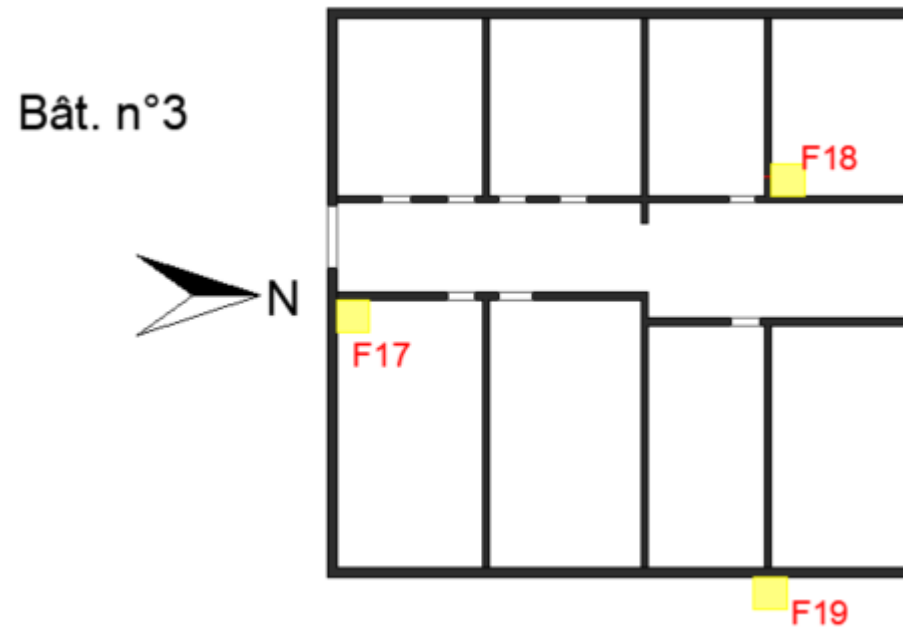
plan d'implantation des investigations géotechniques - Fouilles de reconnaissance de fondation du bâtiment n°3 et 7.
